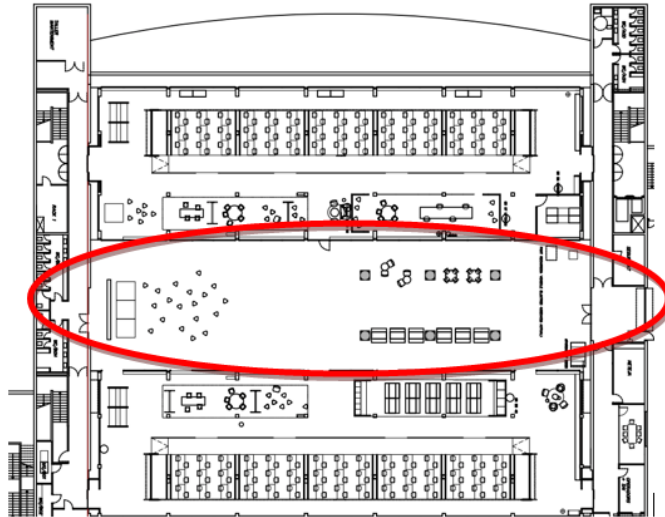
Pati 42 Barcelona, situat a la planta baixa de l'edifici
